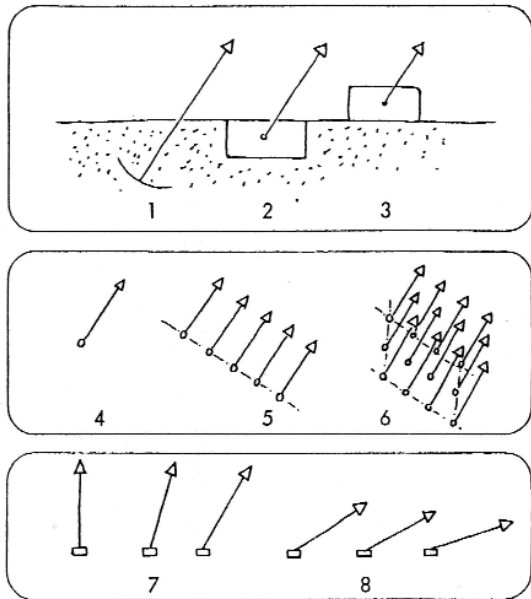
Soportes de red unidimensionales. Fuente: IL 8 pág. 25
